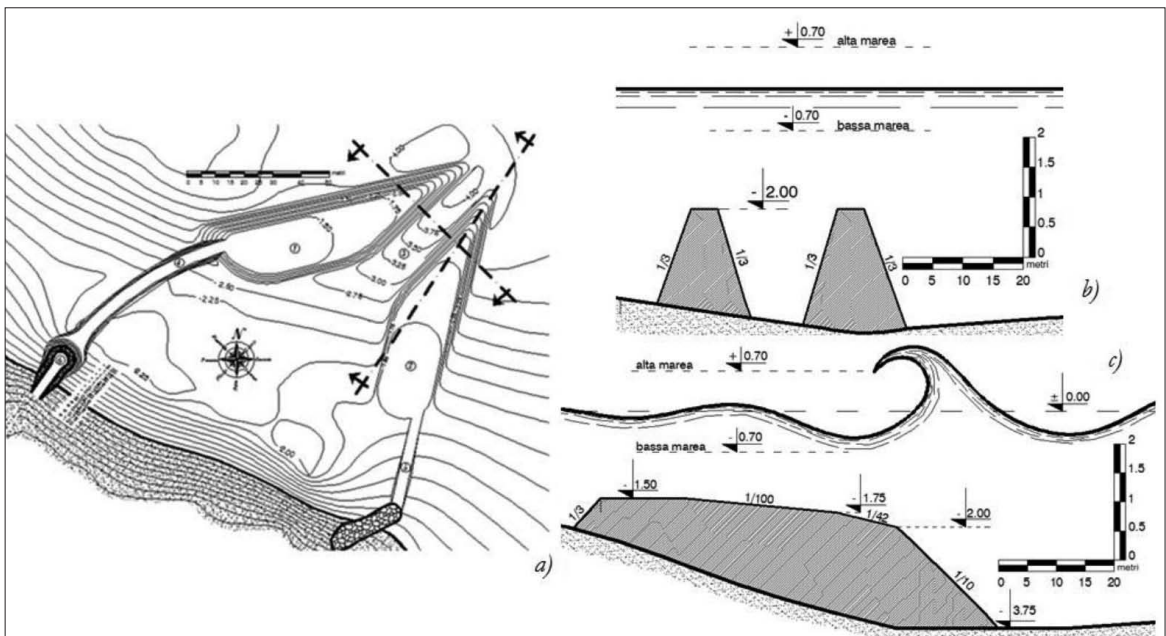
Planimetria a) e profili altimetrici b) e c) della seconda ipotesi di progetto del reef davanti a Porto Verde.
